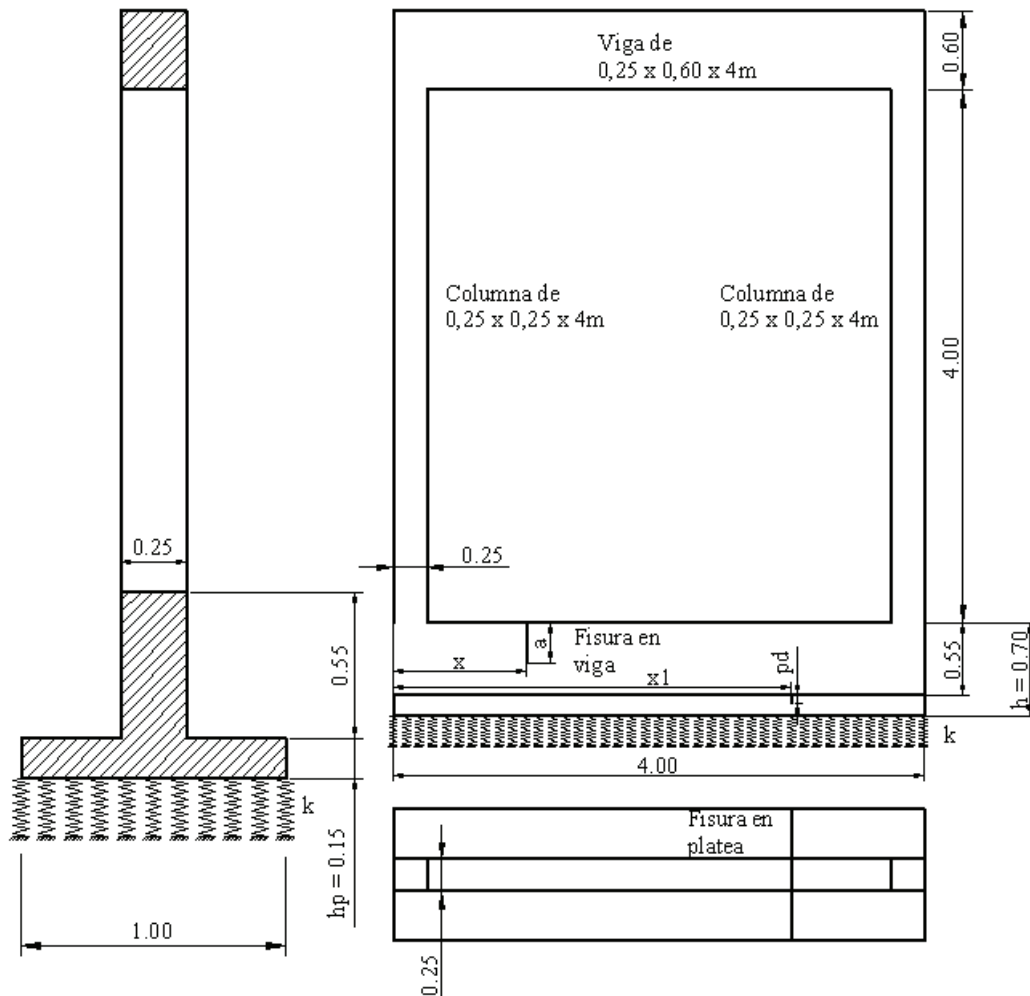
Modelo de Viga de Fundación con fisura en la viga y en la platea para análisis dinámico (unidades de long. en metros)
